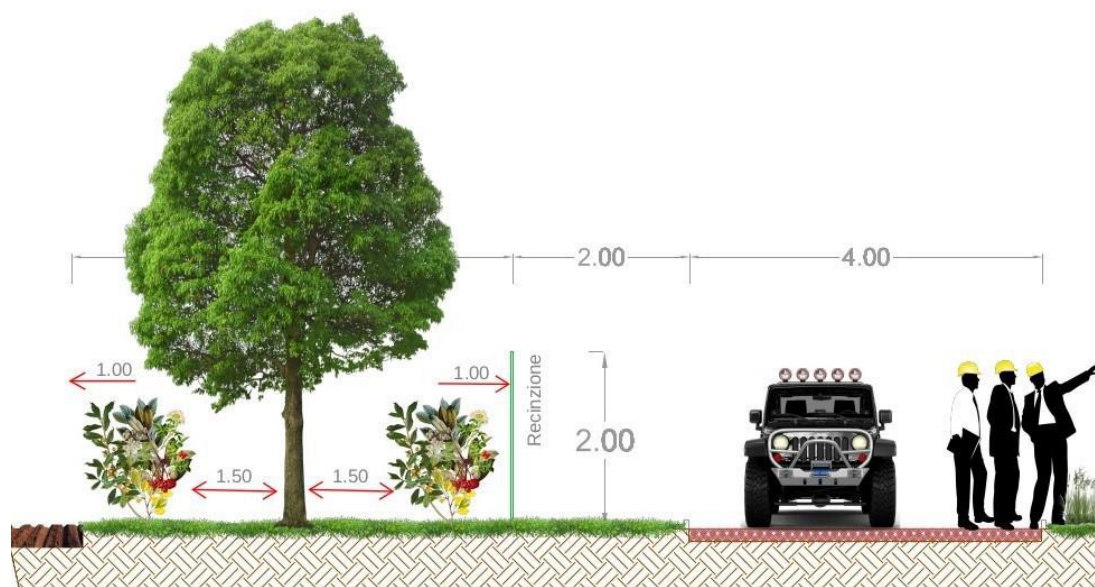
Schema prospettico di piantumazione della fascia tampone
